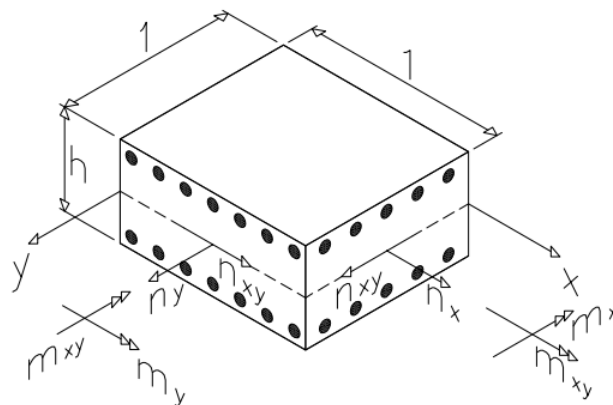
Forças aplicadas num elemento finito em betão armado (Adaptado de Lourenço, 1992).
